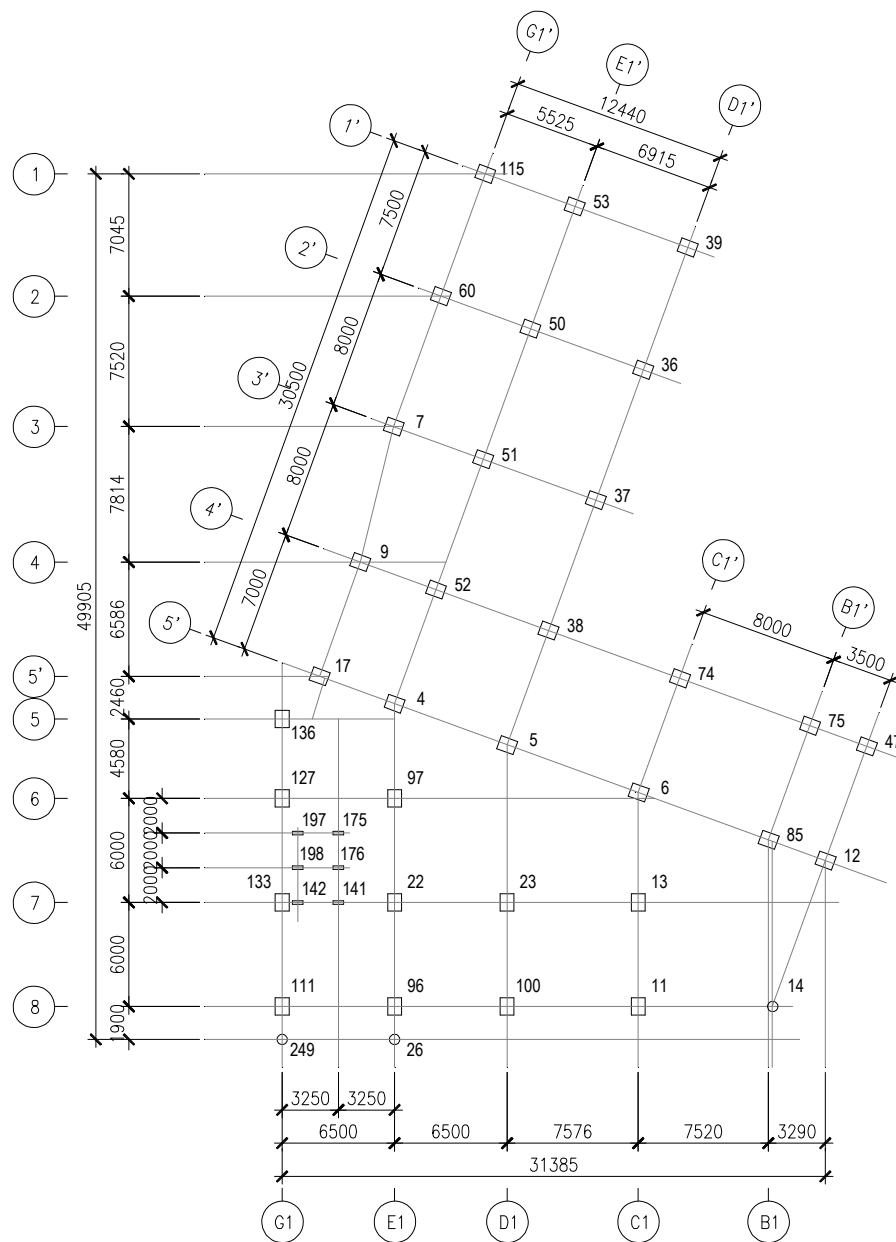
Potongan bangunan Plaza Galara Mall
